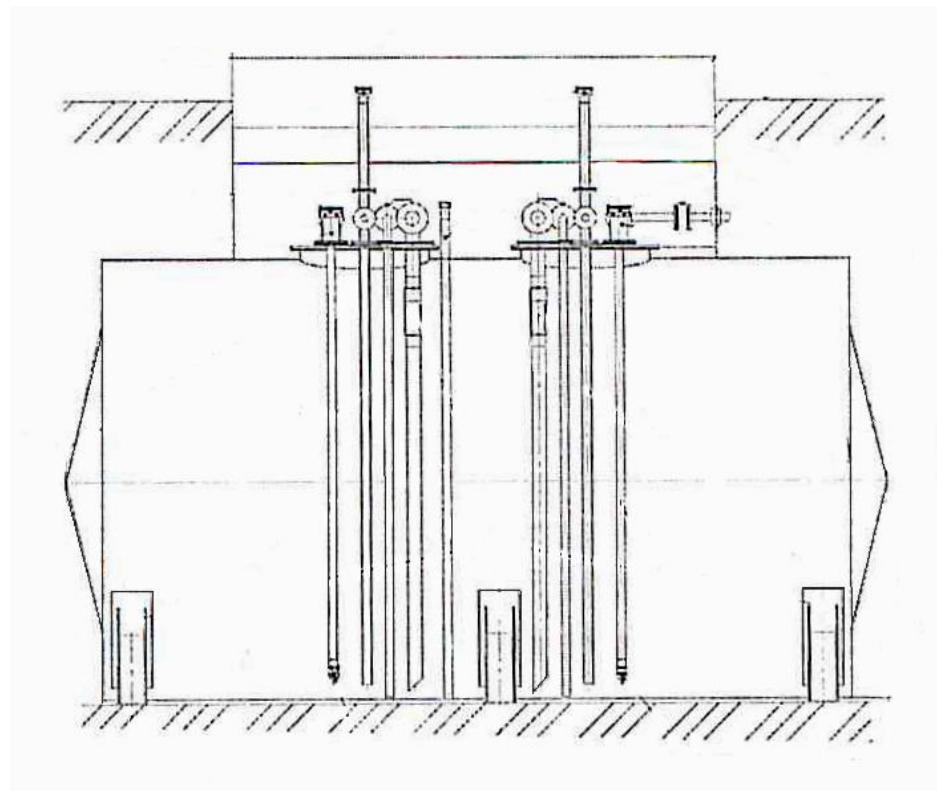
Эскиз резервуаров РГСД-25 №№ 604, 605, 610, 611
